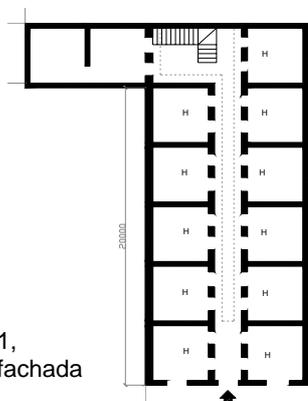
Porvenir 11, ciudadela. Planta y fachada
